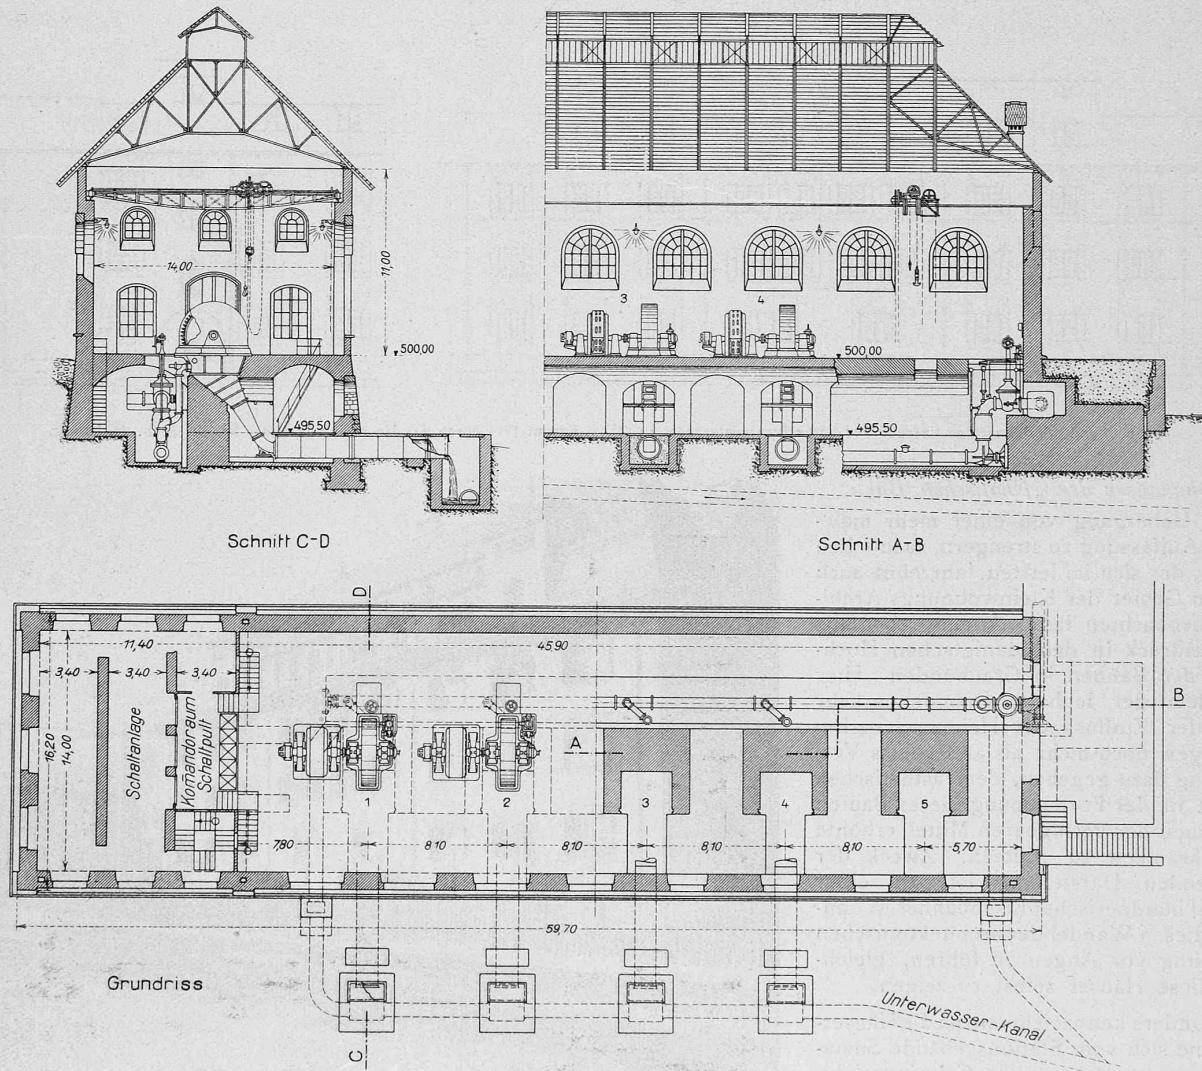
Grundriss und Schnitte des Maschinens- und Schalthauses der Wasserkraftanlage Fully. — Maßstab 1:400.
